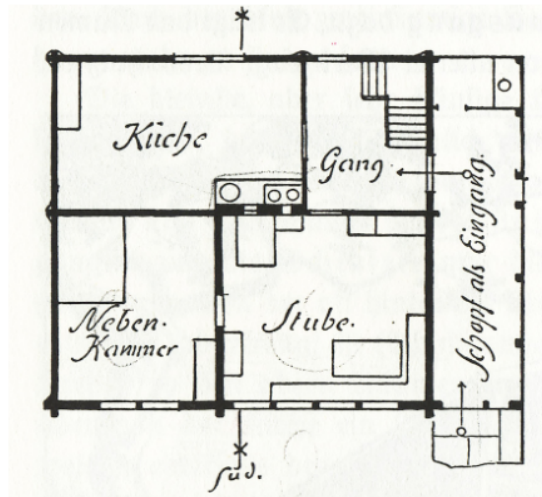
Grundriss eines kleinen Hauses, Erdgeschoss
